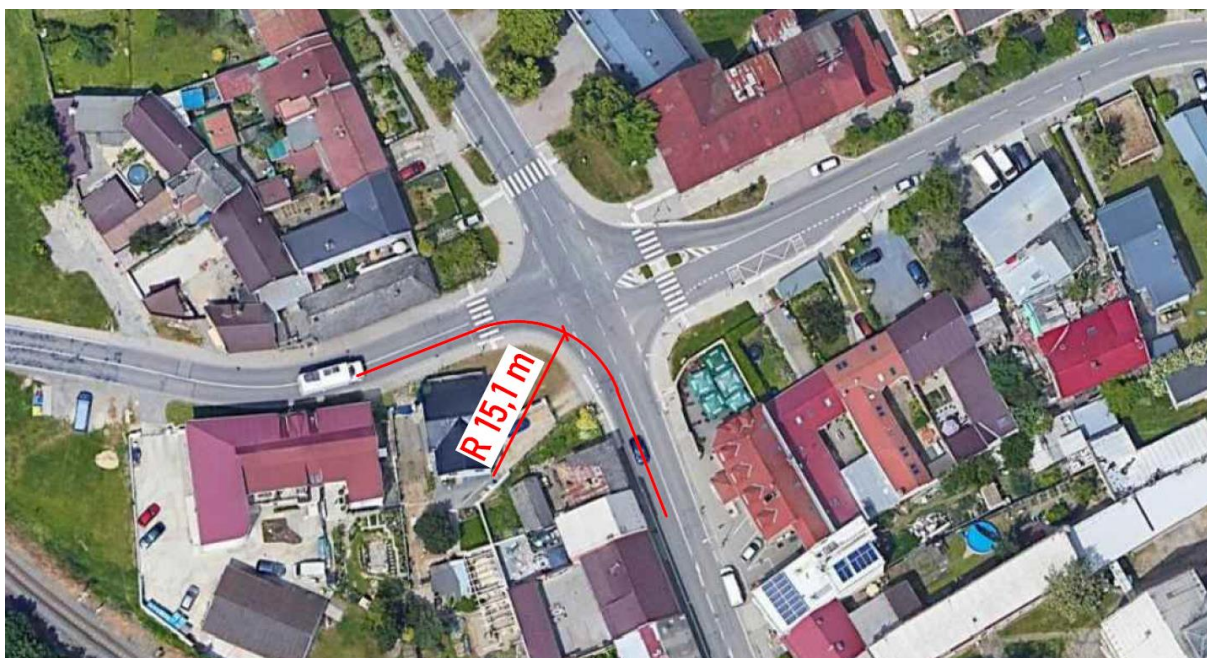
Zatáčka při výjezdu z depa (upraveno autorem) [1]
